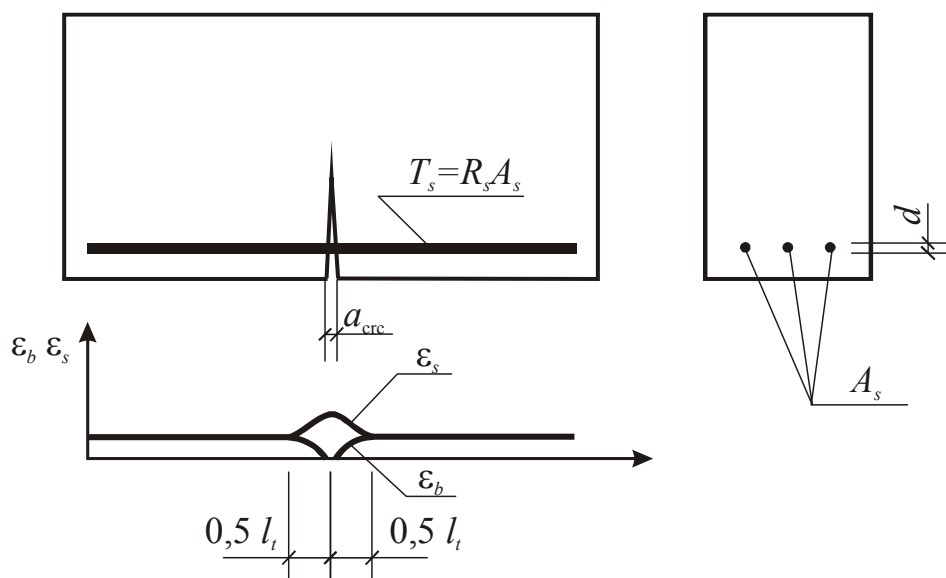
Схема совместных деформаций в бетоне арматуре в зоне трещины
